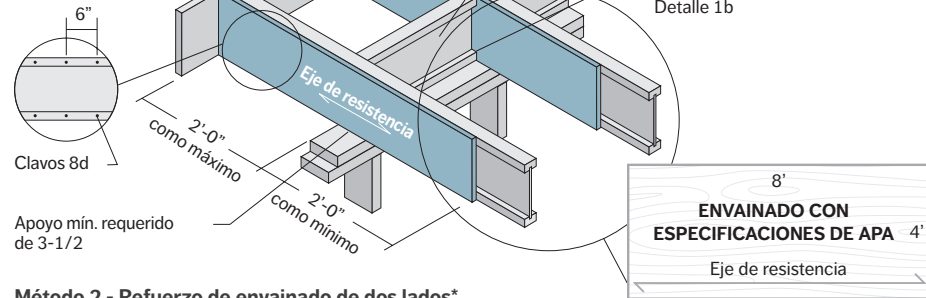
A - MÉTODOS DE REFUERZO PARA VOLADIZO DE VIGUETA RFPI®
